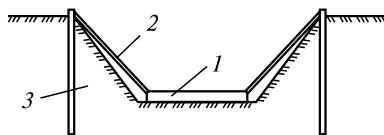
Опирание подкосов на фундаментную плиту:
